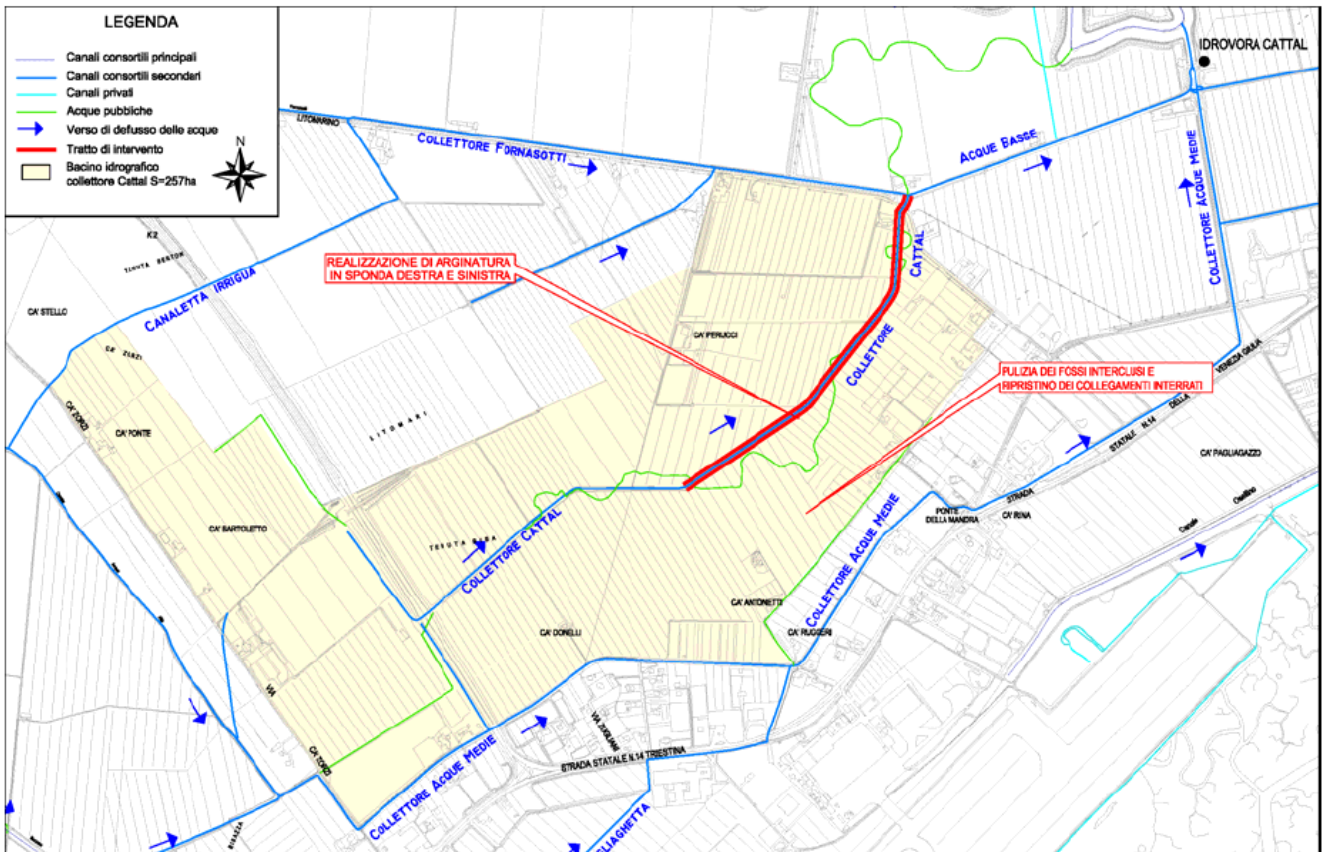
Interventi previsti per la risoluzione della criticità N.1 – planimetria (estratto dal Piano delle Acque del Comune di Venezia).
